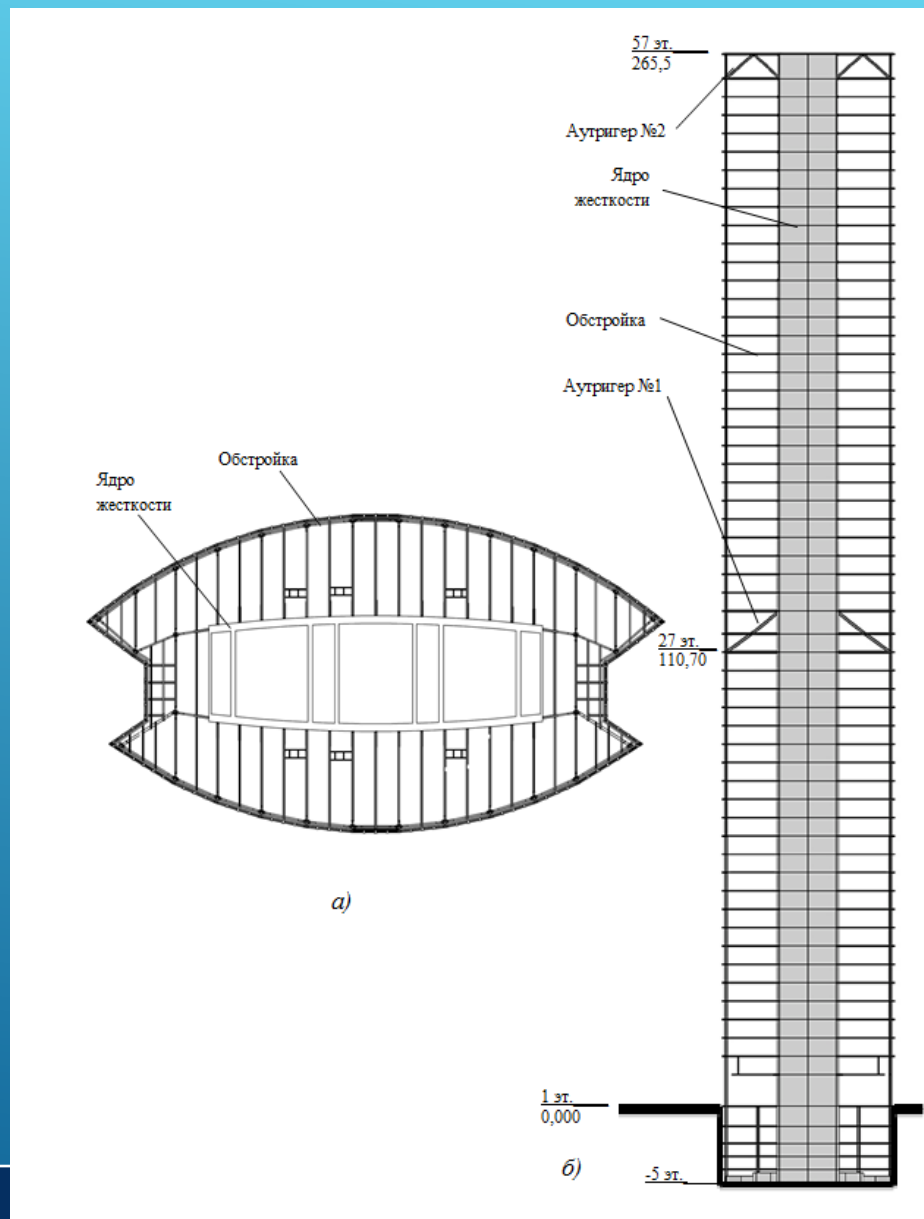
Конструктивная схема блока С высотного здания на участке №10 ММДЦ «Москва-Сити»: а – план типового этажа; б – поперечный разрез
